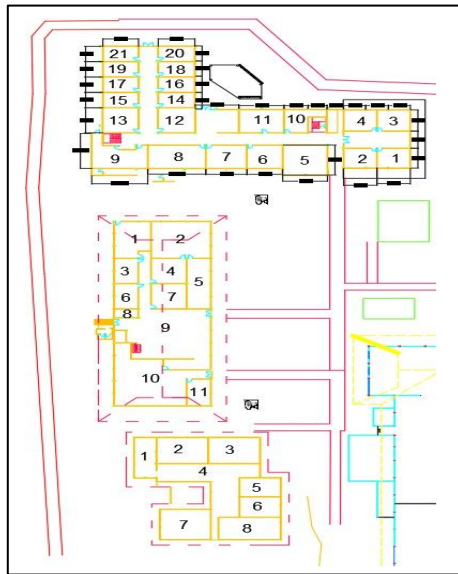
Denah Bangunan Jurusan dan Laboratorium Teknik Elektro
